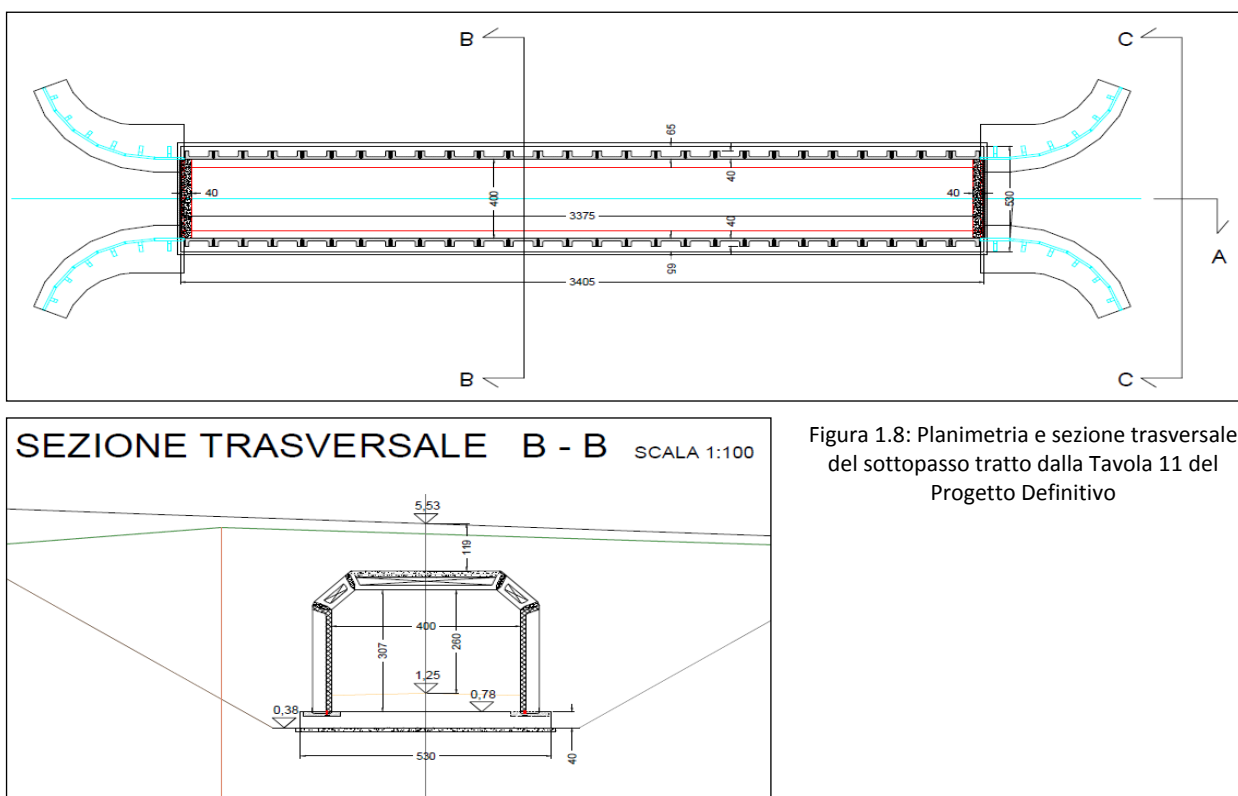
Planimetria e sezione trasversale del sottopasso tratto dalla Tavola 11 del Progetto Definitivo
